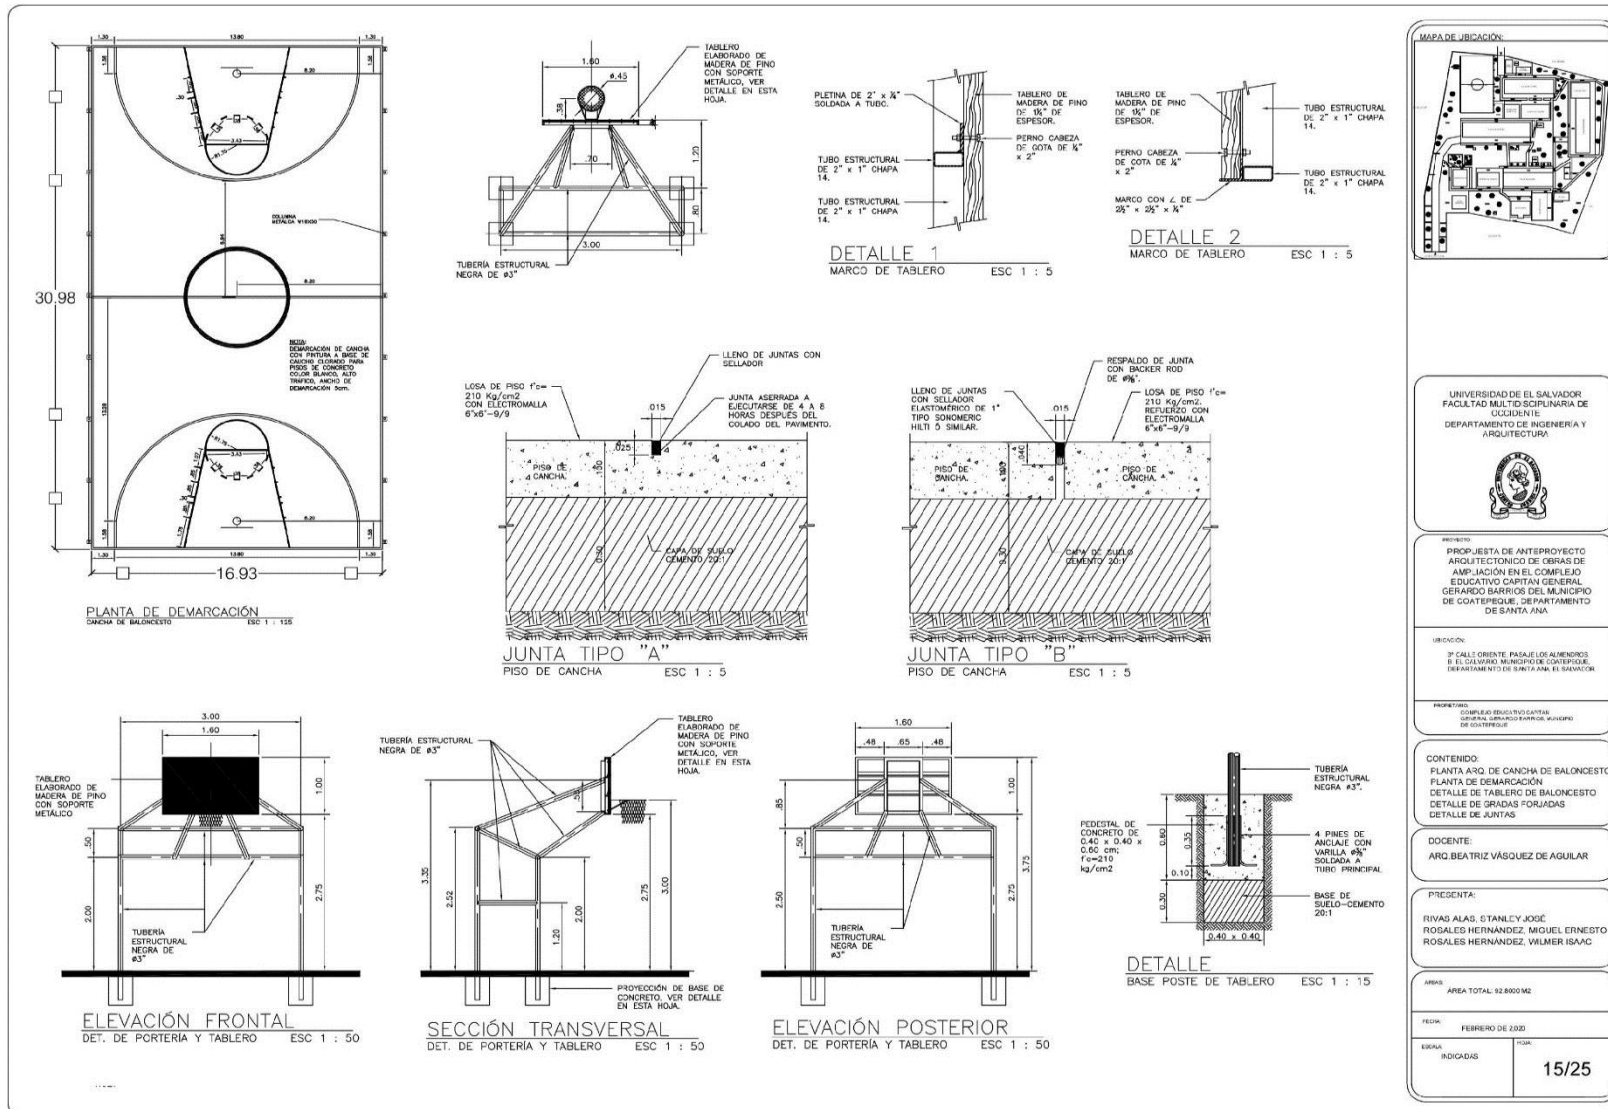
PLANTA ARQUITECTÓNICA, CANCHA DE BASQUETBOL.
